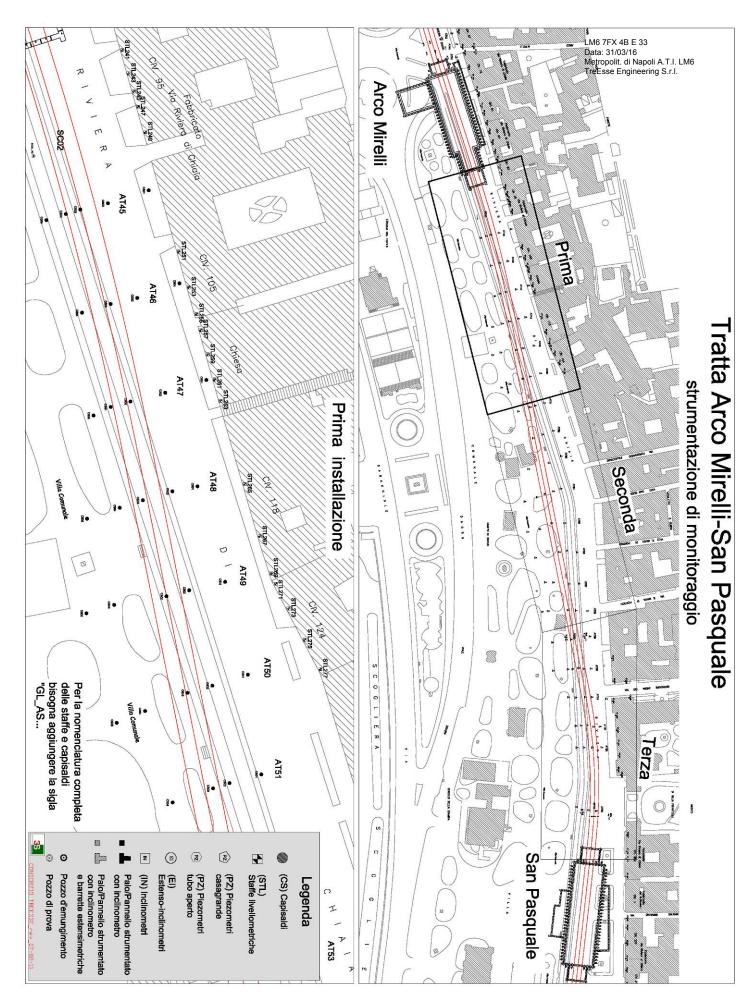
Planimetria tratta Arco Mirelli–San Pasquale, raffigurante la disposizione della prima installazione della strumentazione di monitoraggio.
